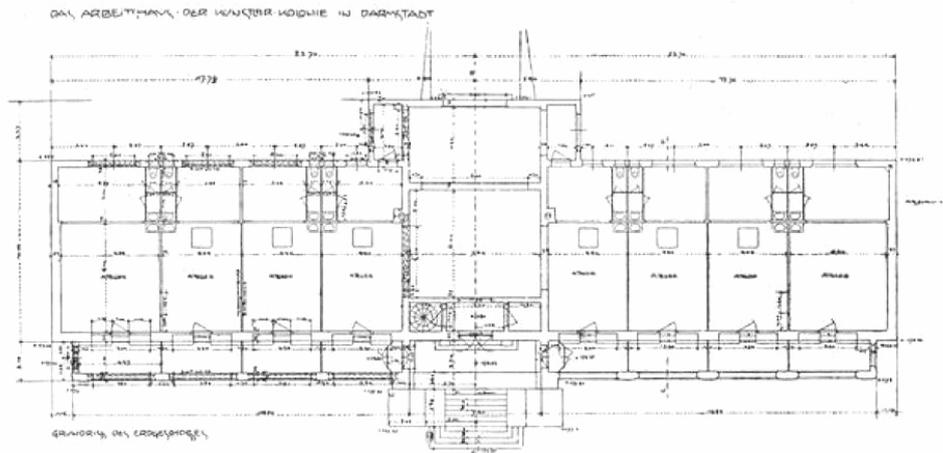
Planta do piso de entrada da *Ernst Ludwing House
